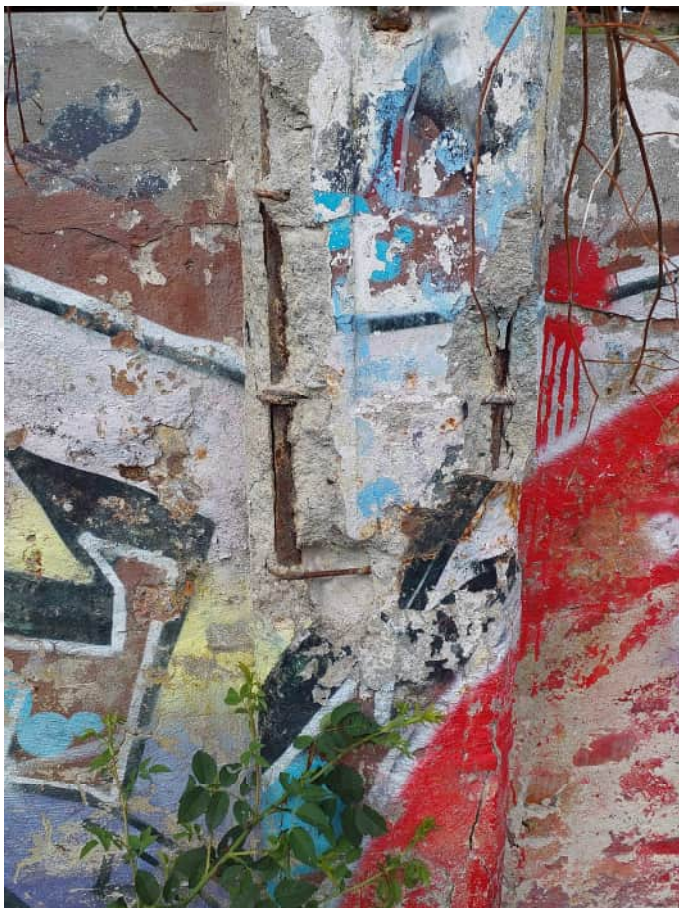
Stahlbetonrahmenstütze mit freiliegender Bewehrung
